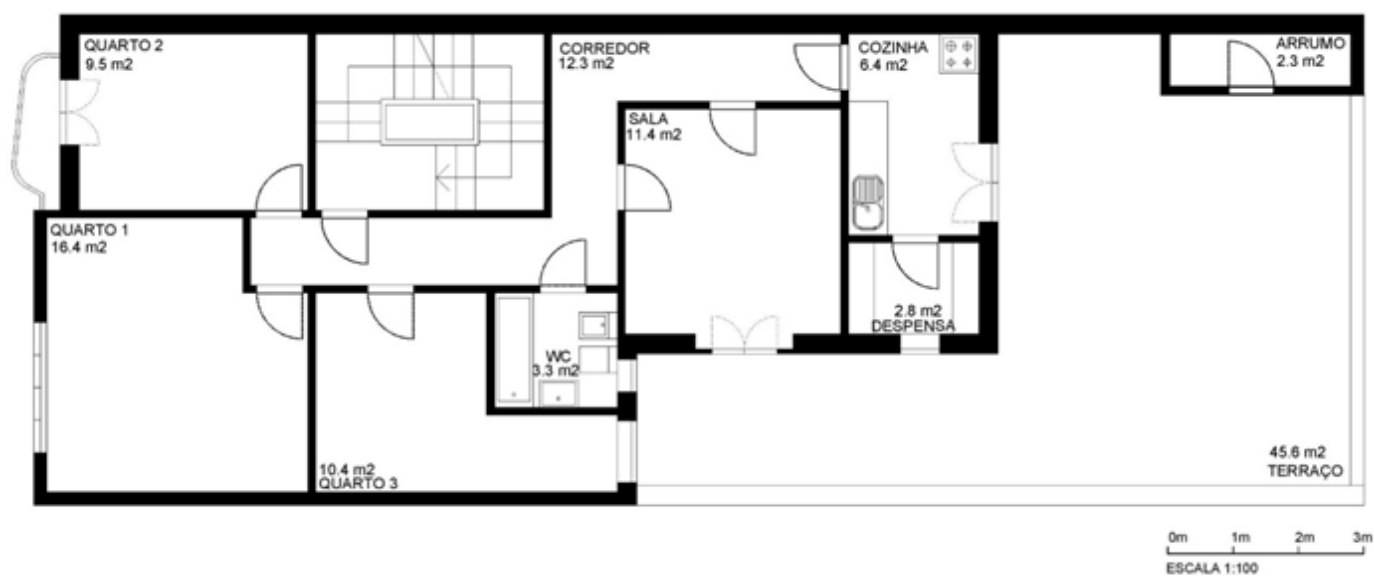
Planta do imóvel atual, antes da intervenção.
